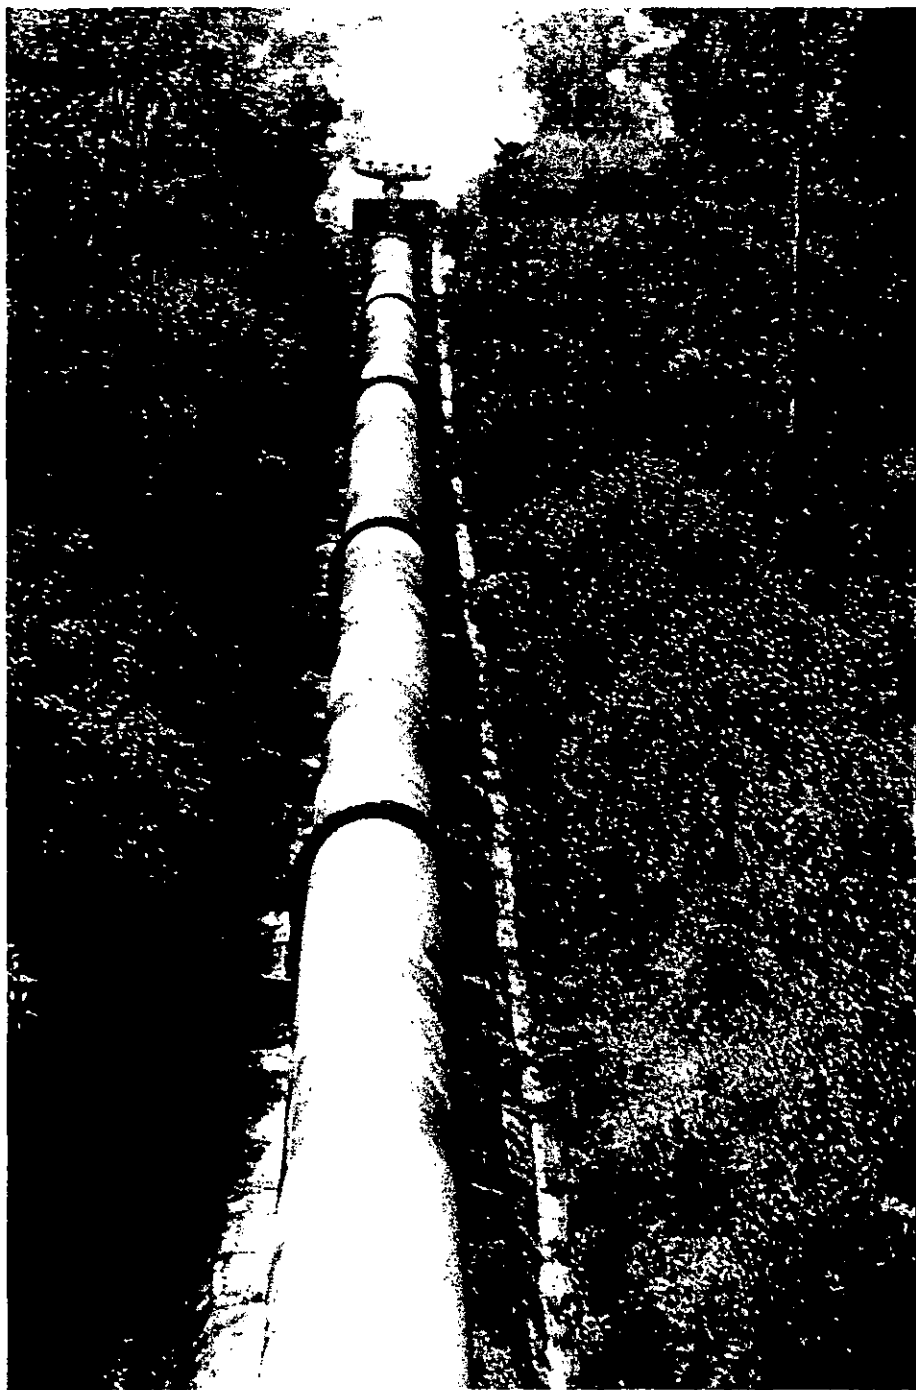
Altura disponible y tubería de presión. Caída "Las Palmas".
